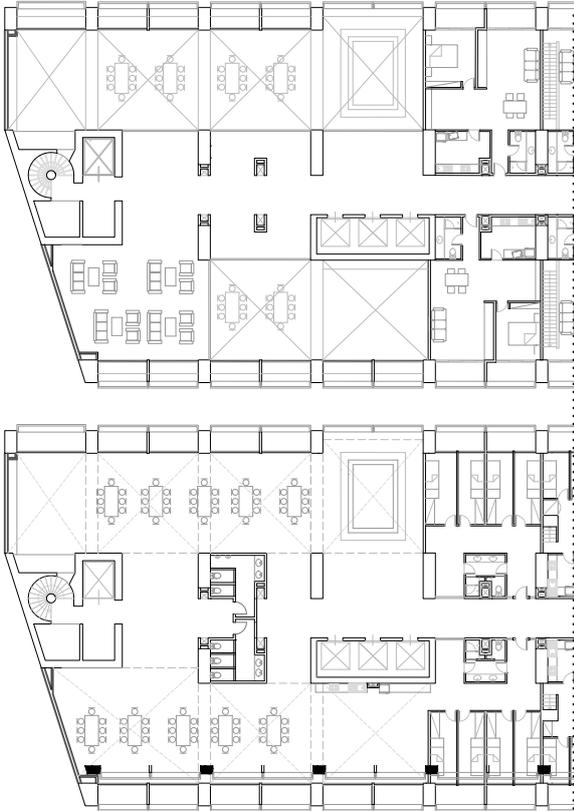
Planta da cozinha comunitária, escala: 1/200
